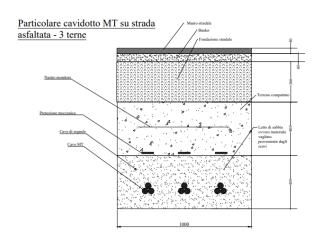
Sezione tipo cavidotto su strada asfaltata
